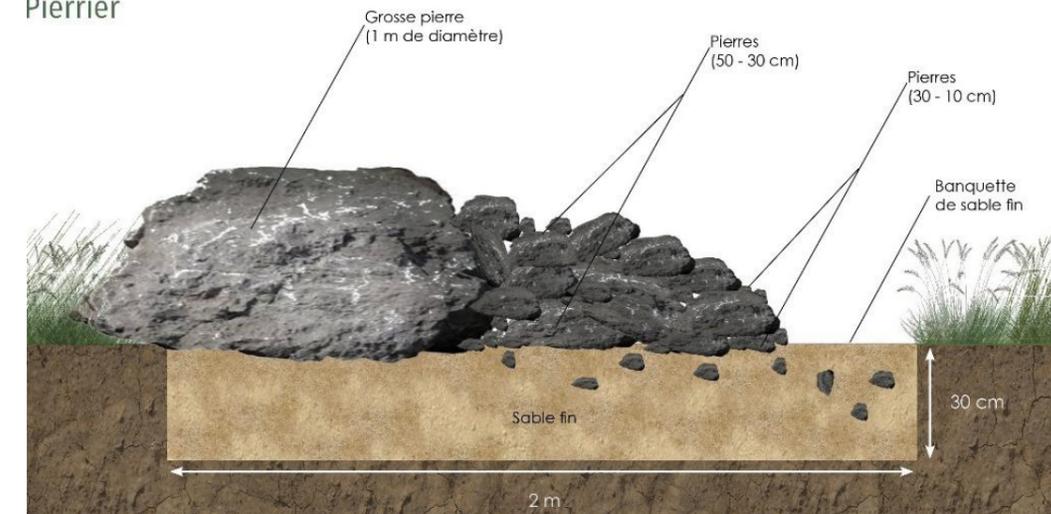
Pierrier type à mettre en place sur le site (Confluences)
